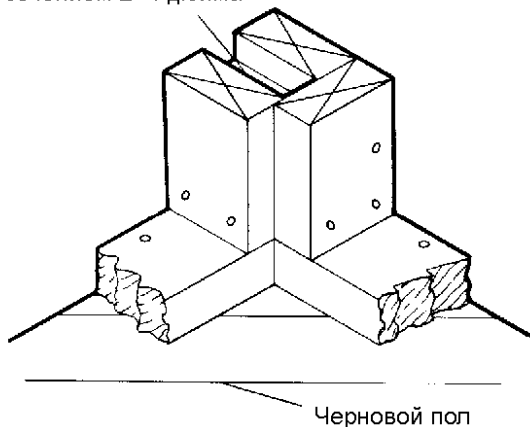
Вторая стена крепится гвоздями к двойной стойке угла (Forest Products Laboratory)
